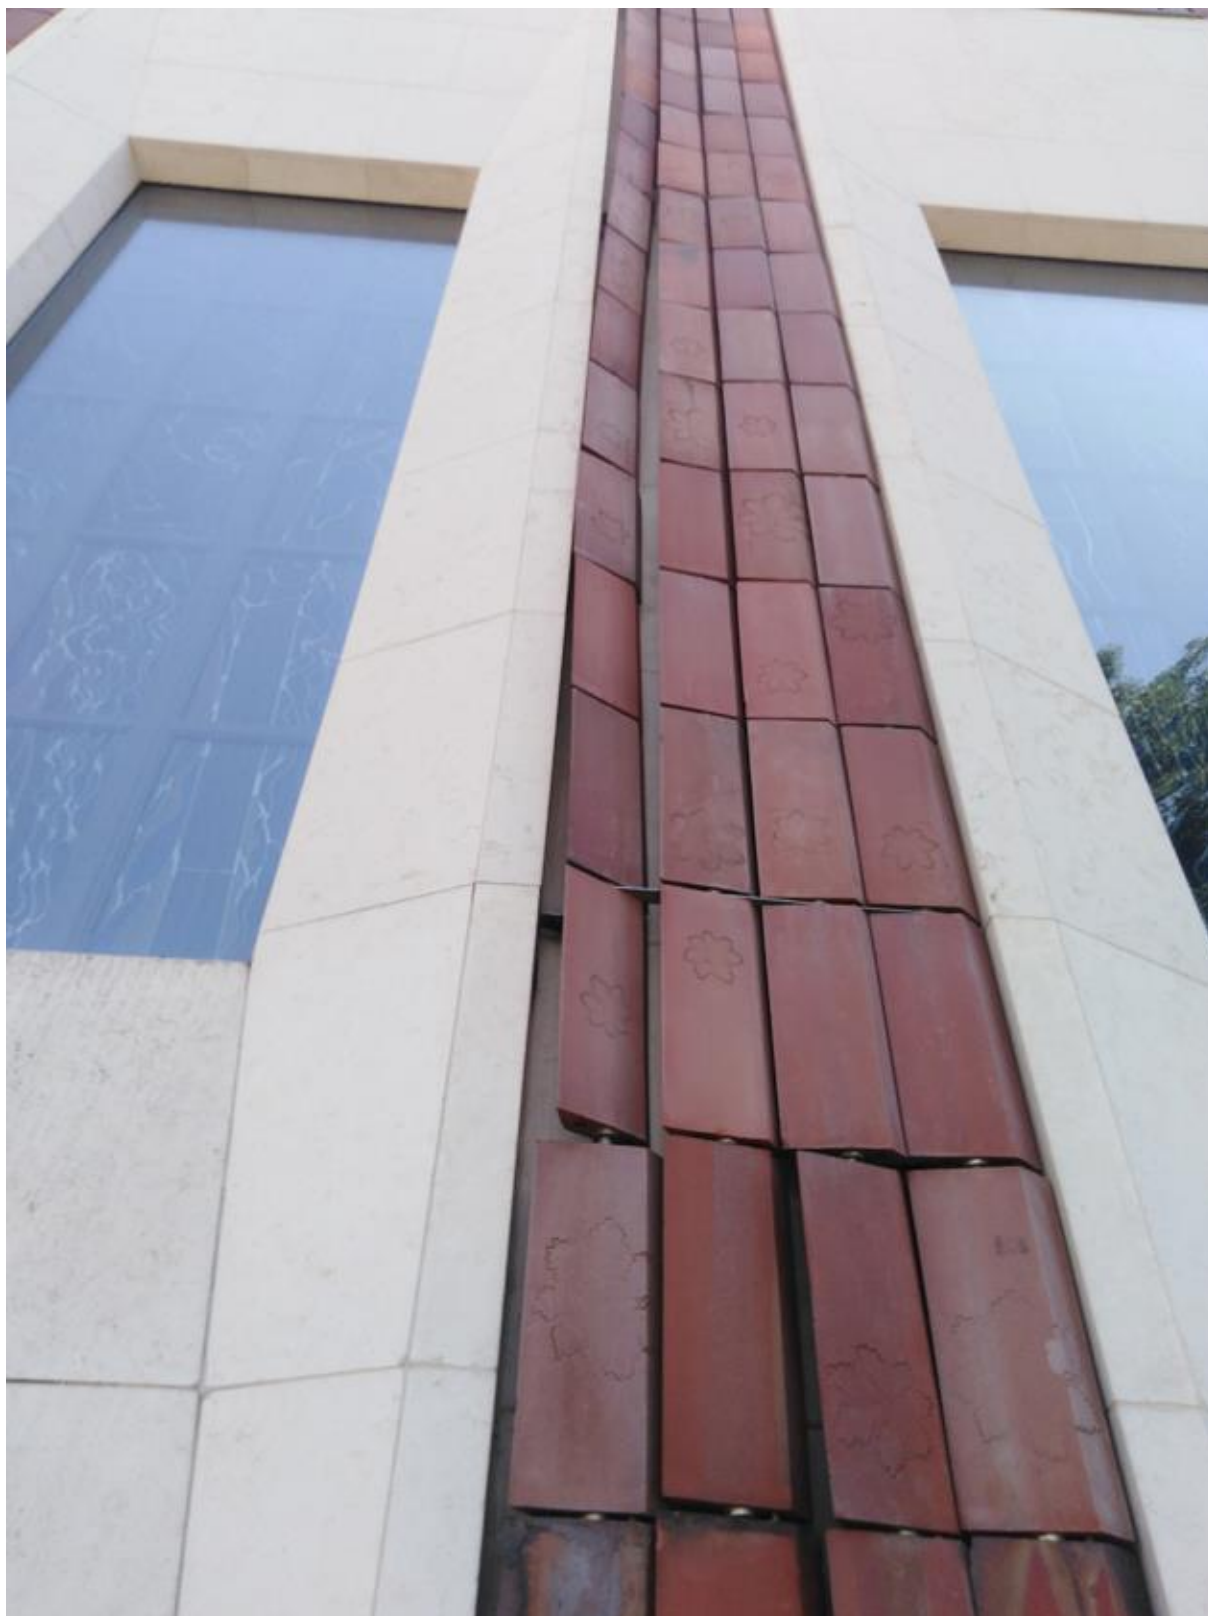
Elewacja północna - od placu Wszystkich Świętych
